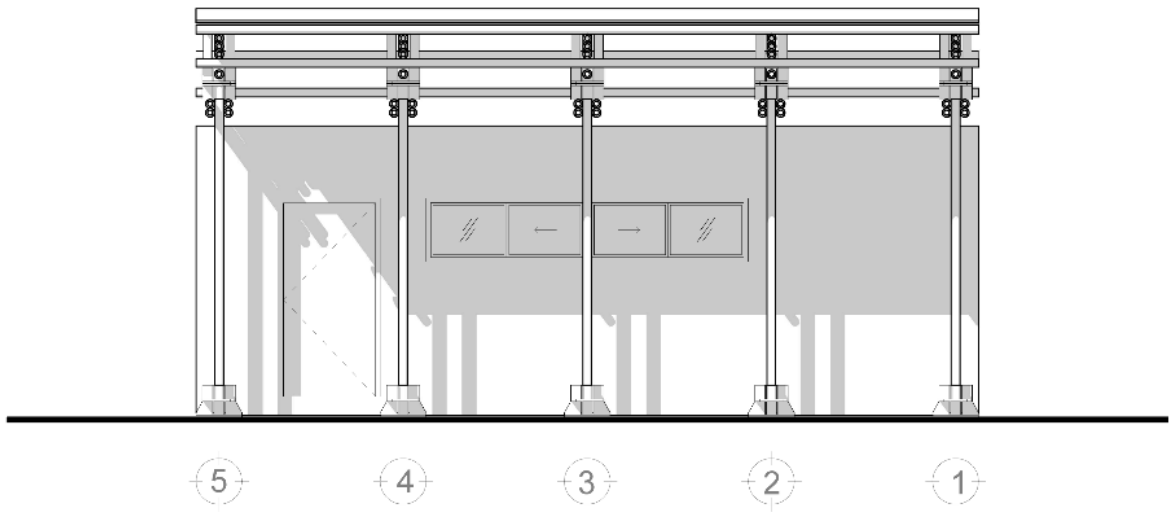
Fachada Este. Fuente: Gerardo A., 2022.
